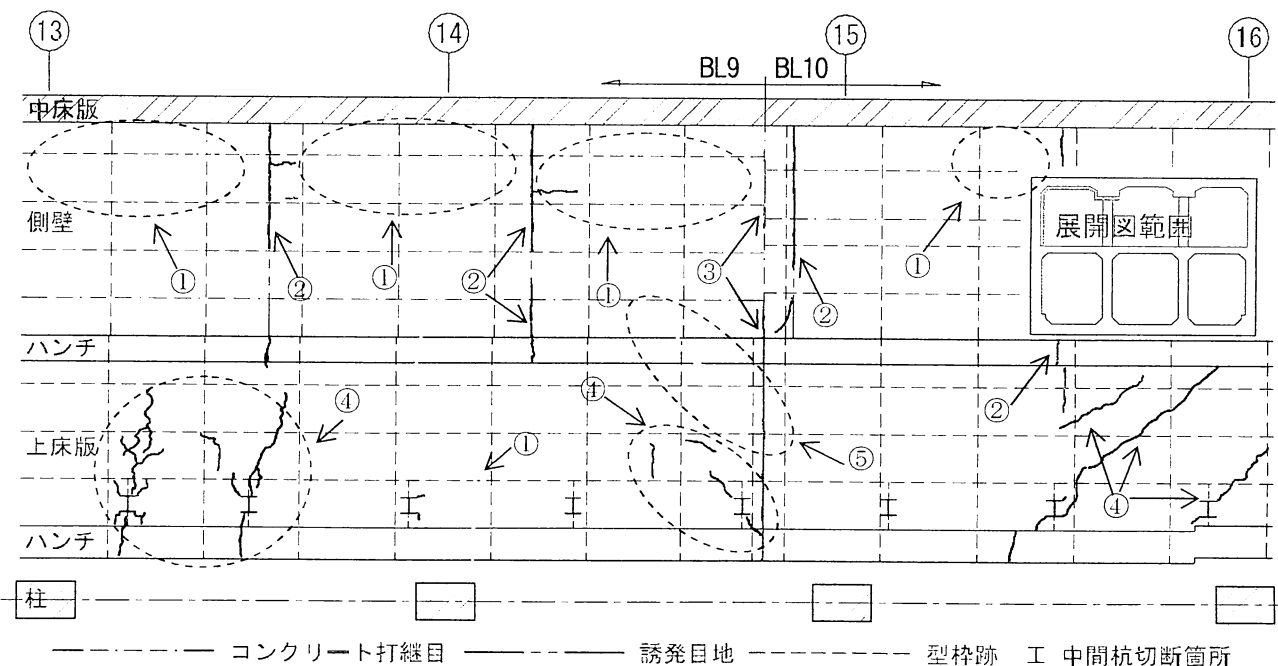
ひび割れ変状展開図<sup>7)</sup>
